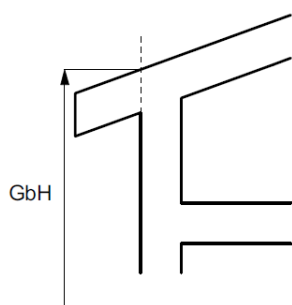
Gebäudehöhe, Dachraum, Gesamthöhe:
